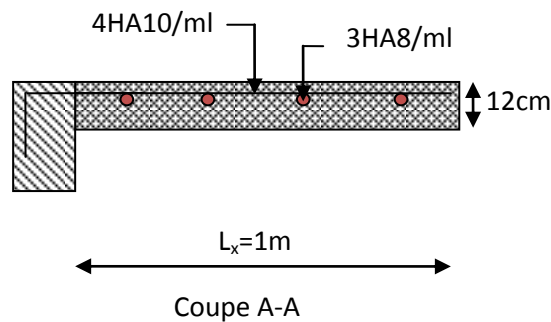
schéma de ferrailage de la dalle avec un seul appui.
